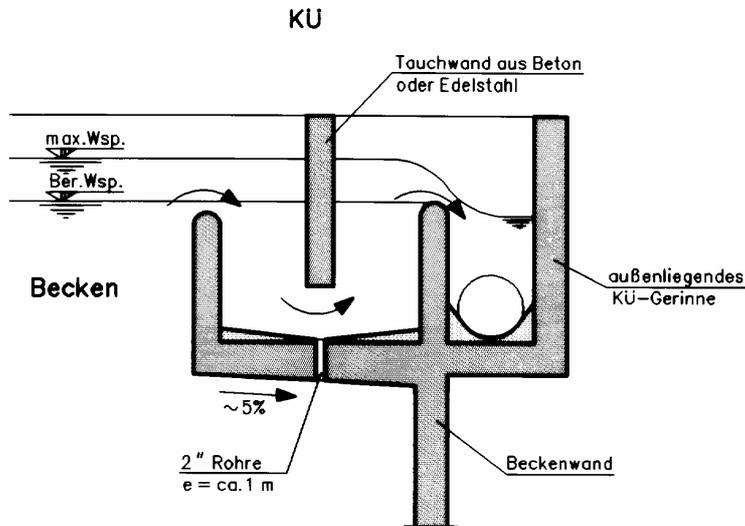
Einstaubarer Klärüberlauf mit Siphon
